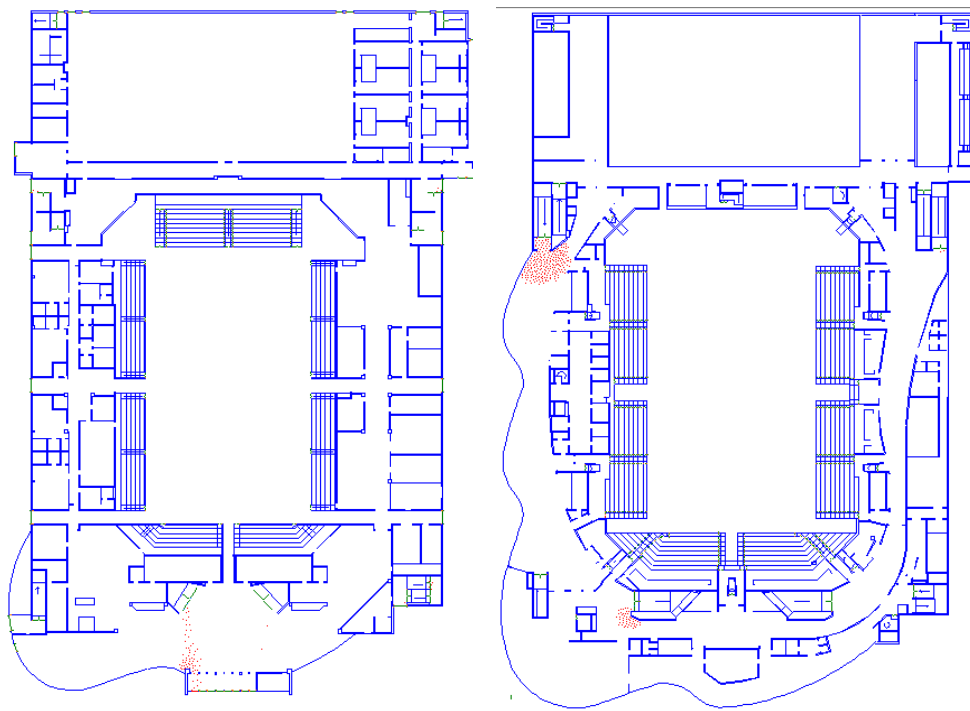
Simuleringens utseende efter 180 sekunder. Till vänster syns plan 1 och till höger plan 2.
